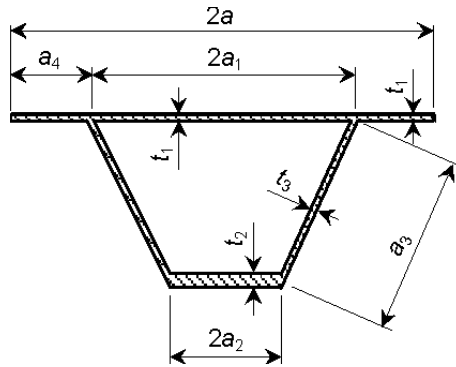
Simbología para rigidizadores de la sección transversal
